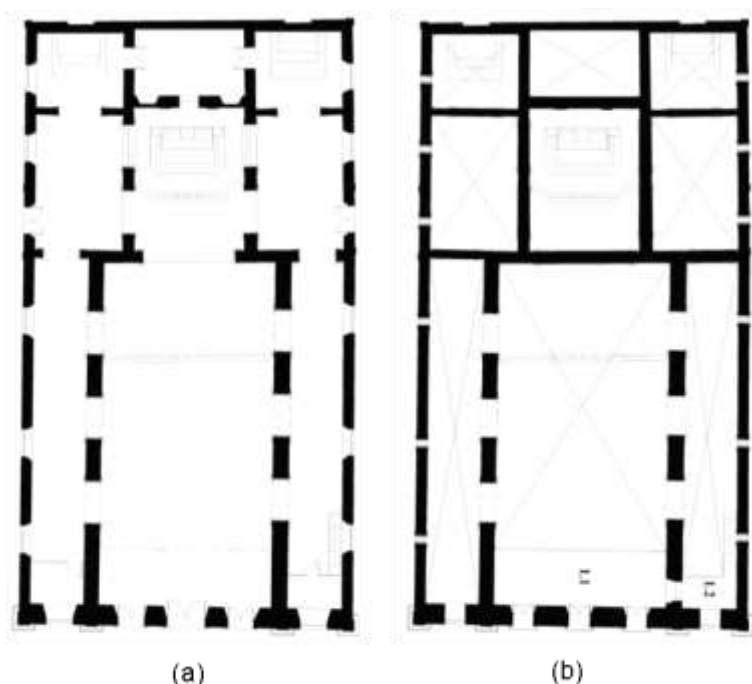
Planta baixa da área interna da igreja: a) pavimento inferior; b) pavimento superior
